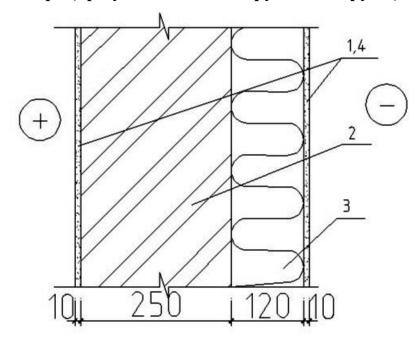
Конструкция утепления стены снаружи с использованием в качестве утеплителя плит из минеральной ваты.
